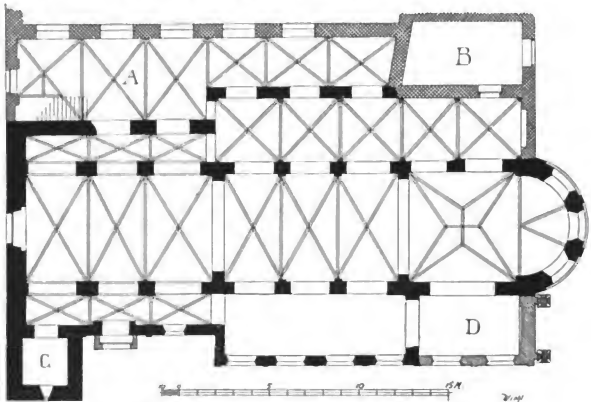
Neuwerk. Grundriss der Klosterkirche.
